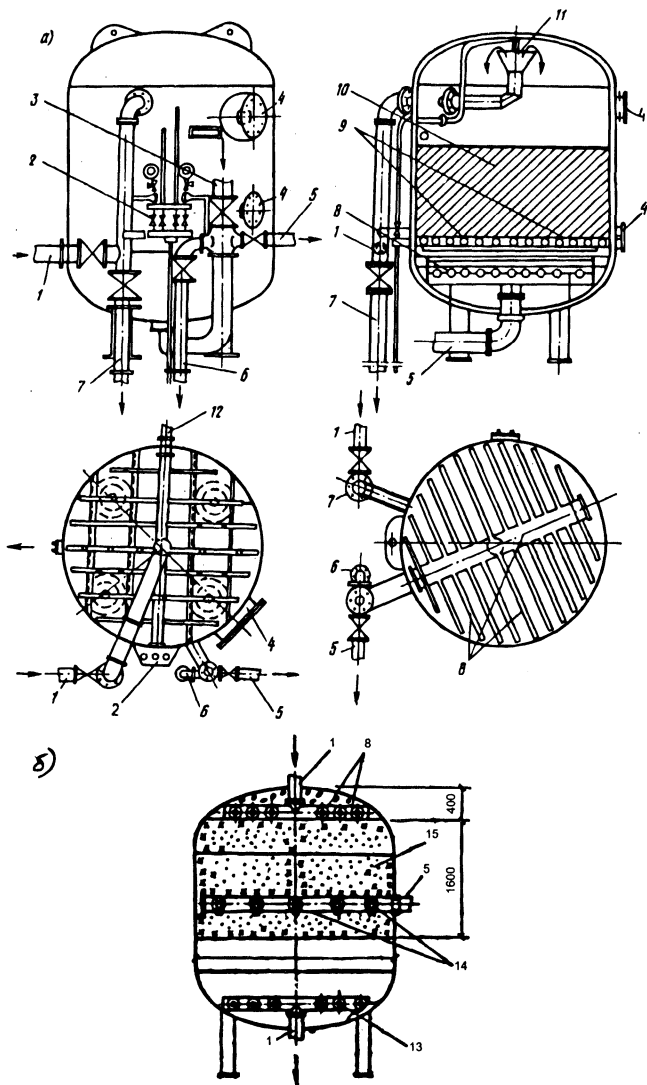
Вертикальный напорный скорый фильтр (а) с керамзитом (песчаной) и (б) пенополистирольной загрузкой:
